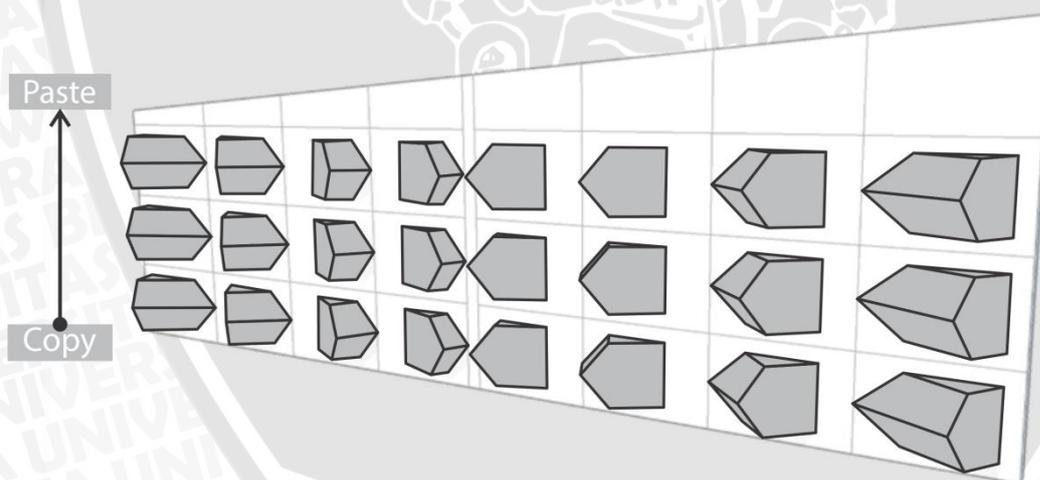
138 Penerapan Konsep Tampilan Bangunan (I)
